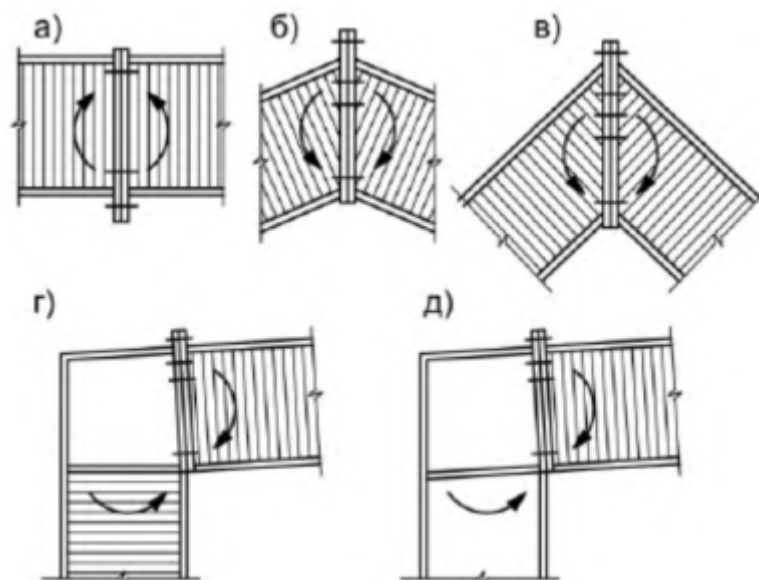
Основные типы фланцевых соединений: а) соединения параллельных элементов; б, в) соединения элементов рам под малым углом; в) соединения элементов под большим углом; г) сопряжение ригеля и колонны с гофрированными стенками через вставку с плоской стенкой; д) сопряжение ригеля с гофрированной стенкой и колонной с плоской стенкой
